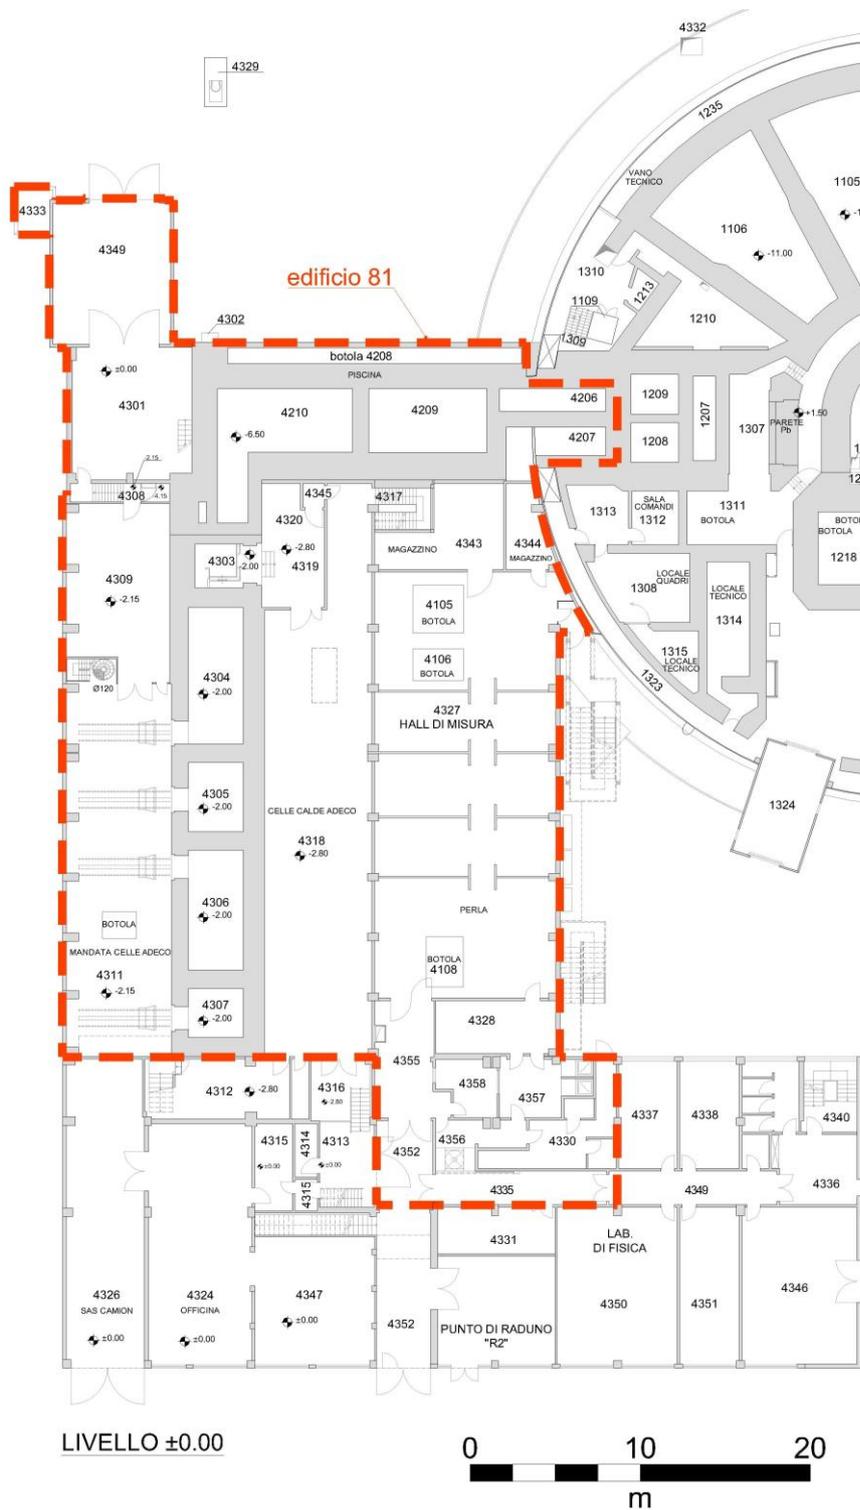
Edificio 81 – Layout a ±0,00 m
